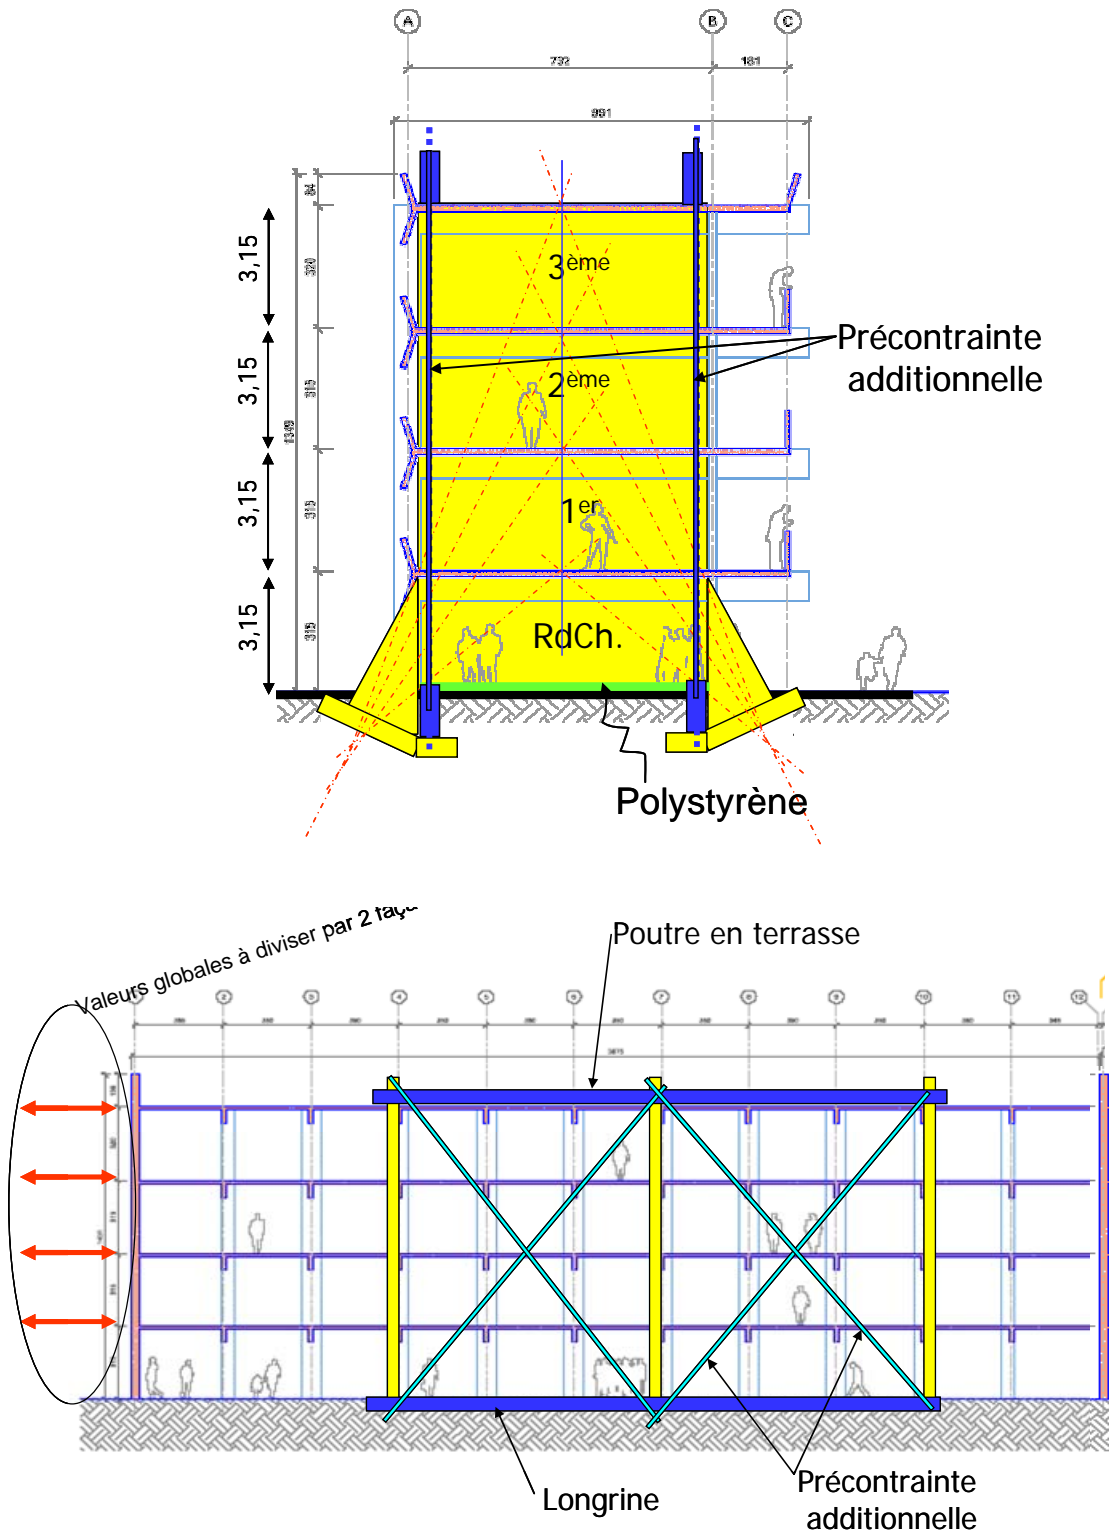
Renforcement transversal par voiles en béton armé projeté et renforcement longitudinal par précontrainte additionnelle
